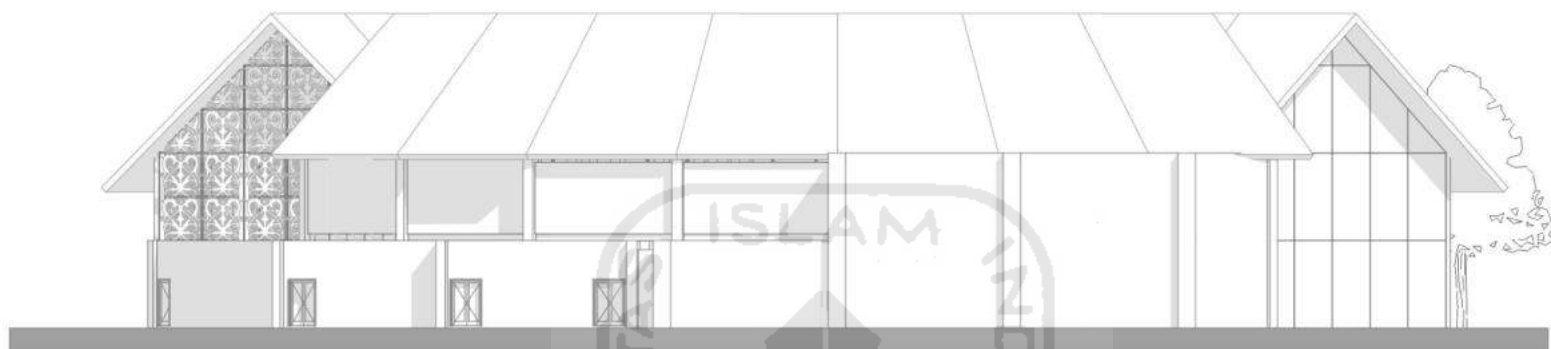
Tampak barat bangunan workshop (*Sumber: Penulis, 2021*)
